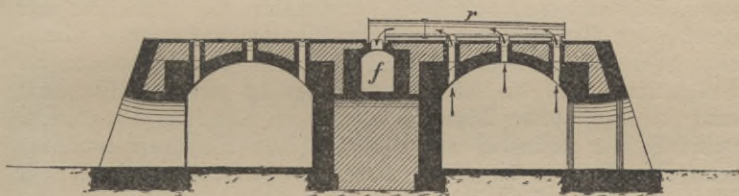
Ringofen mit oberem Rauchabzug. Querschnitt.
